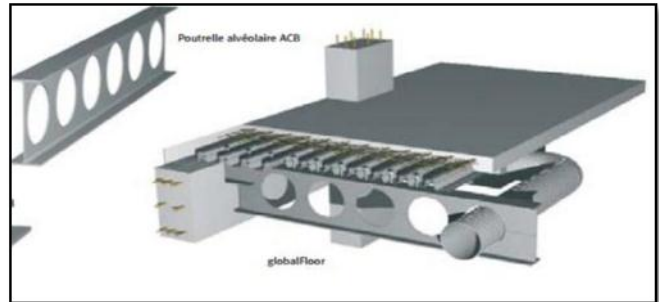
Plancher collaborant mixte avec poutre alvéolaire
